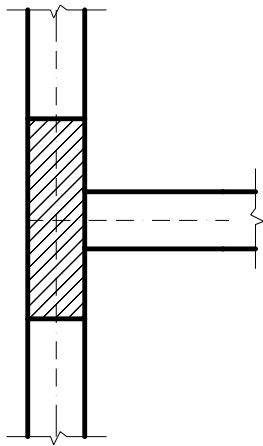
Arranjo estrutural do pilar na planta de fôrma e dimensões da seção.
